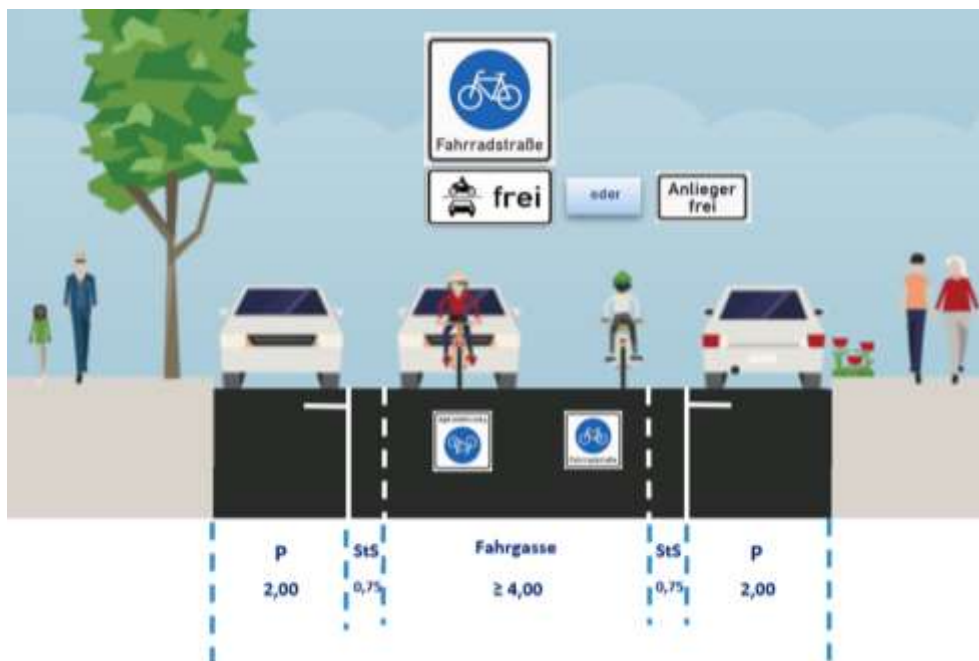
Markierungsstandard für Querschnitte in Fahrradstraßen mit Parkflächen in beiden Fahrtrichtungen
